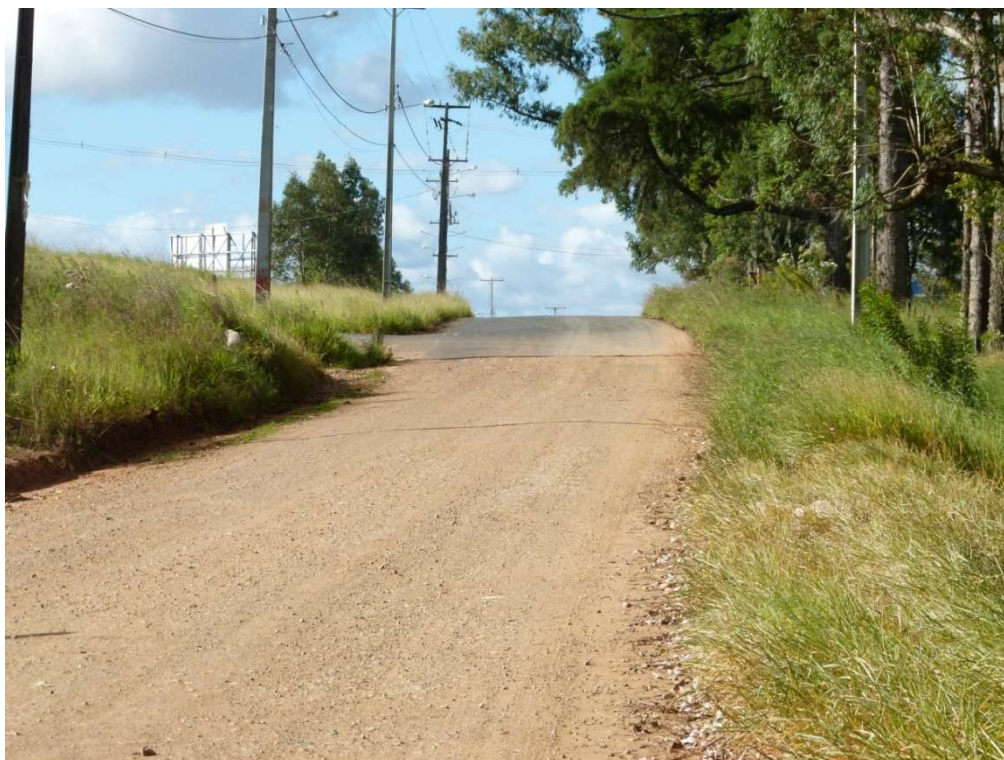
Vista da Avenida Eduardo Burgardt com Avenida General Aldo Bonde.
